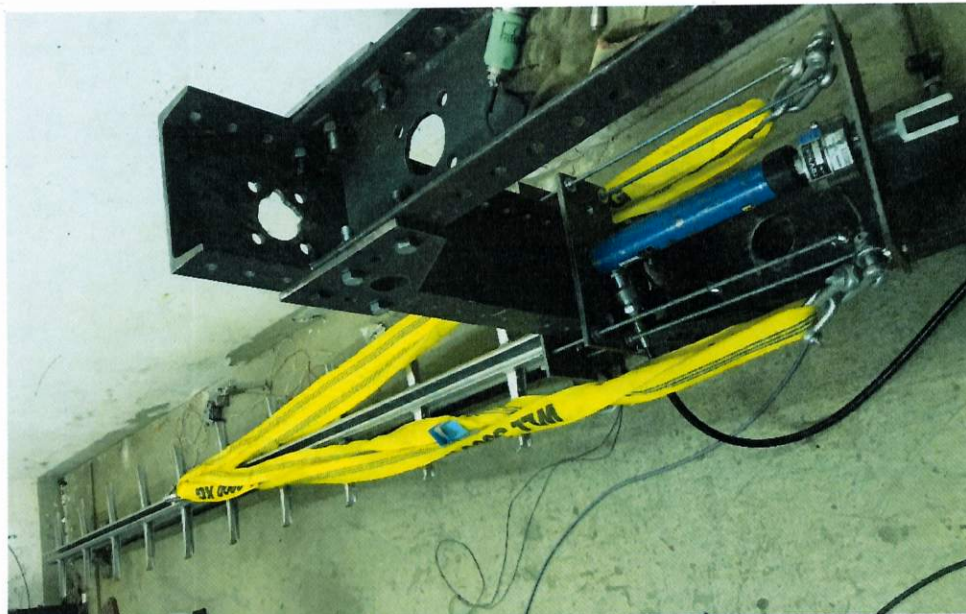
Prüfaufbau für horizontale Belastungsprüfung am
